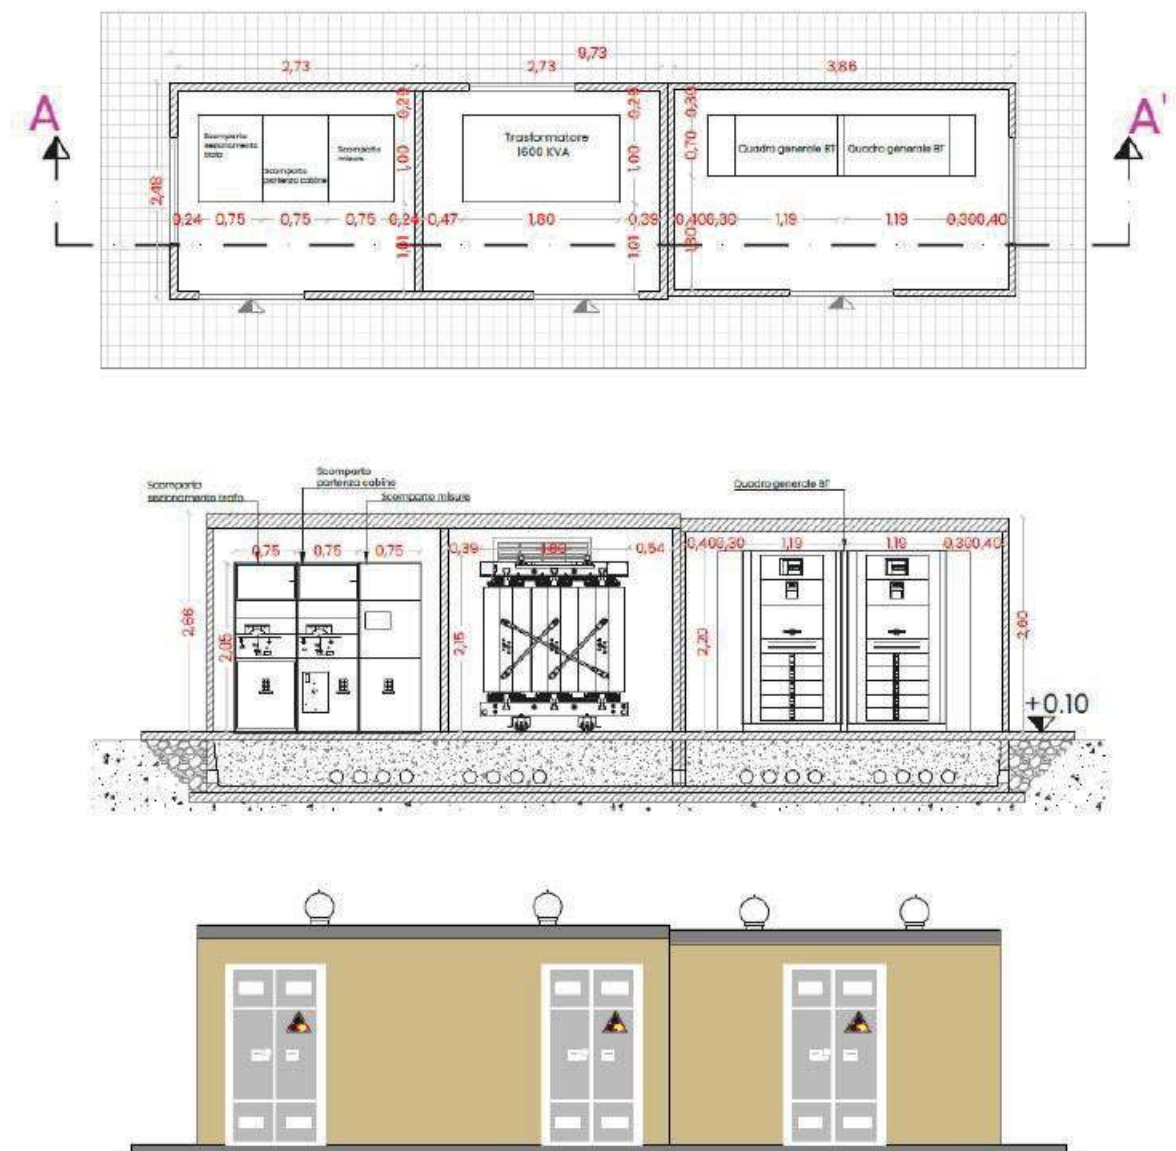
pianta, sezione e prospetto delle cabine di trasformazione relative al progetto
